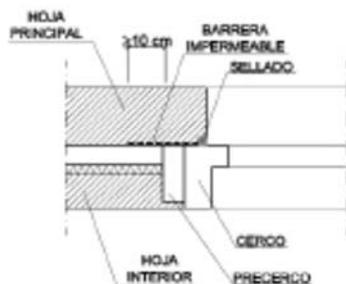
Ejemplo de encuentro de la fachada con la carpintería
